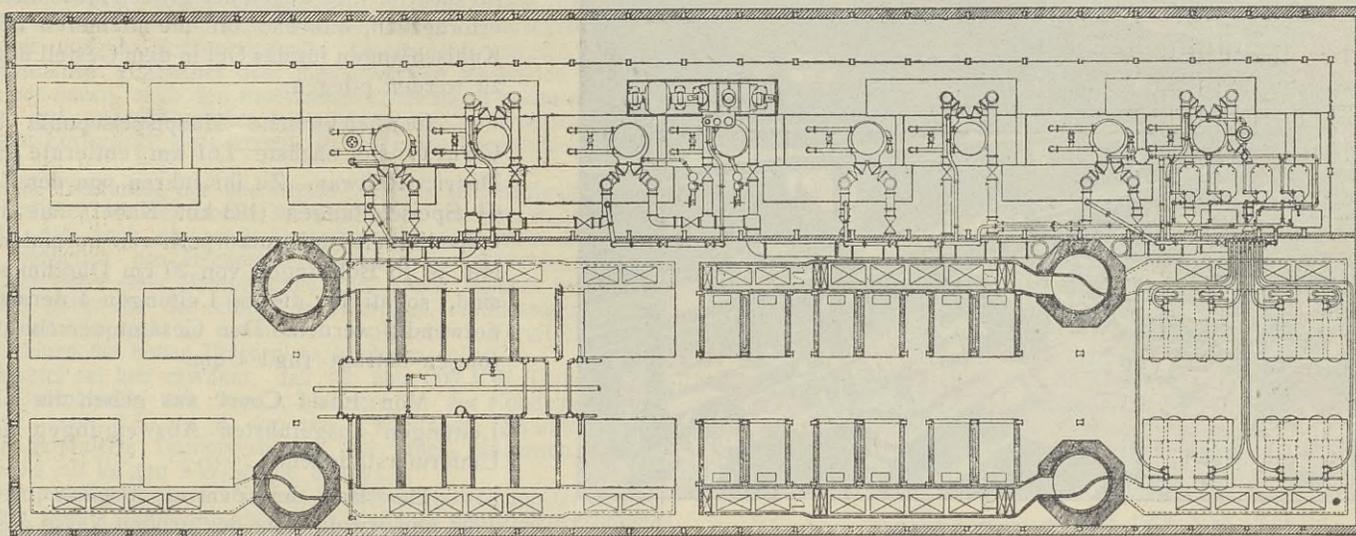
Grundriss des Maschinen- und Kesselhauses.
